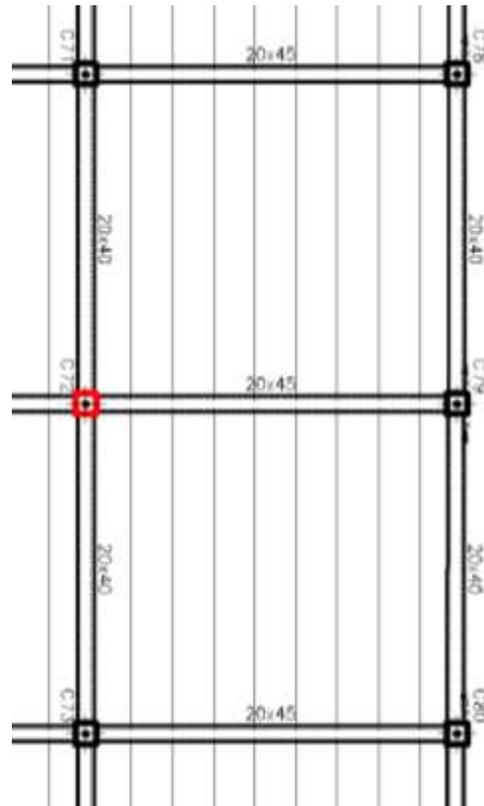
Elementos estructurales más solicitados (Vista en planta)
